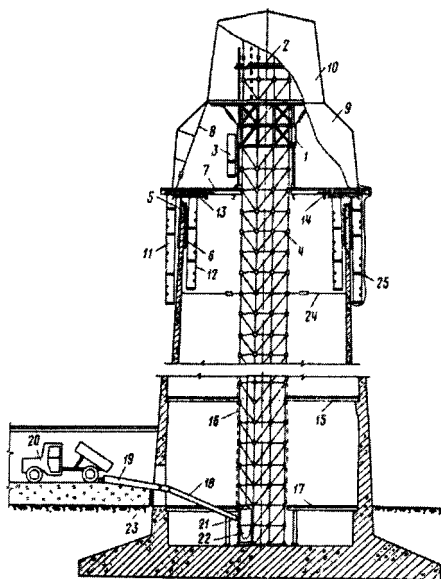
Схема подачи бетонной смеси на рабочую площадку для бетонирования ствола трубы:
